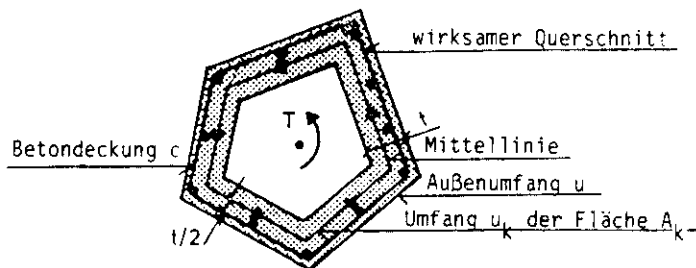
Formelzeichen und Begriffe nach Abschnitt 4.3.3.1
